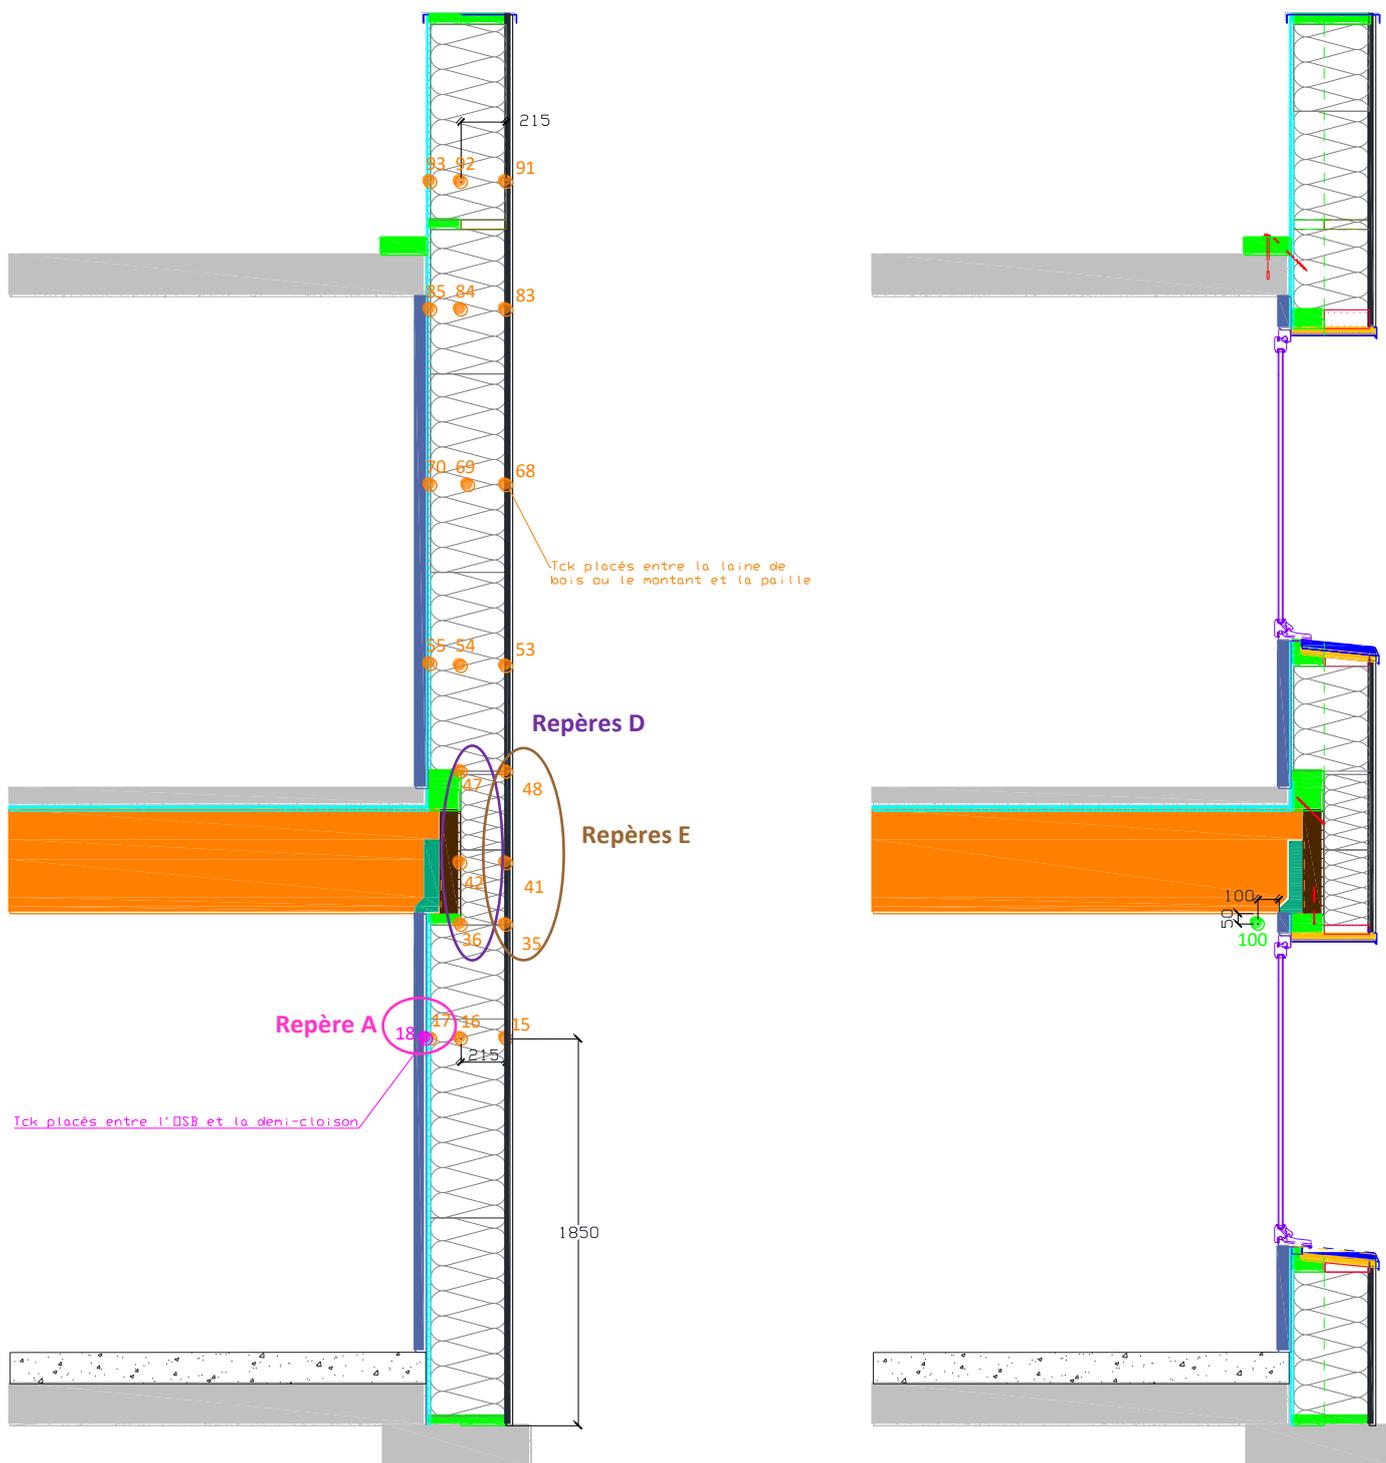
Instrumentation de l'élément de façade - (A gauche) : Coupe G-G - (A droite) : Coupe H-H
